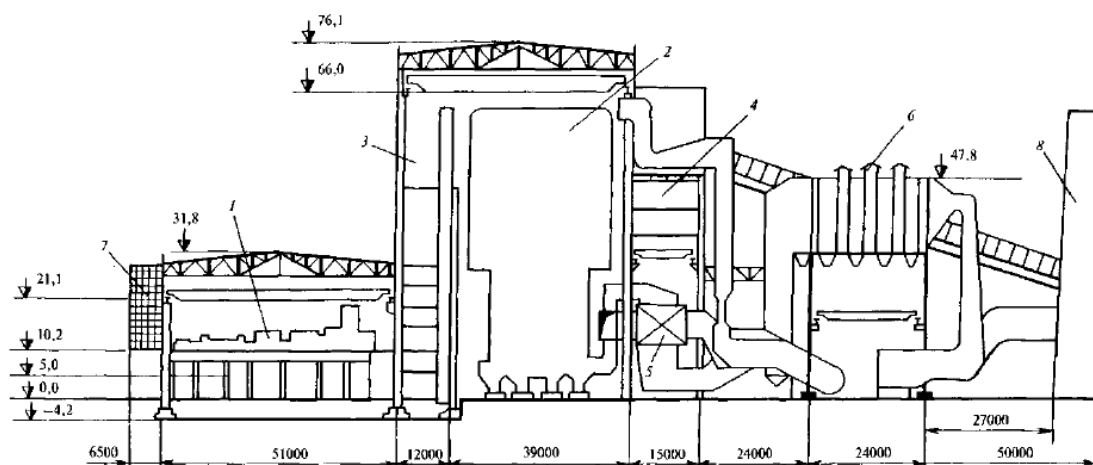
Поперечный разрез главного корпуса Экибастузской ГРЭС-1:
